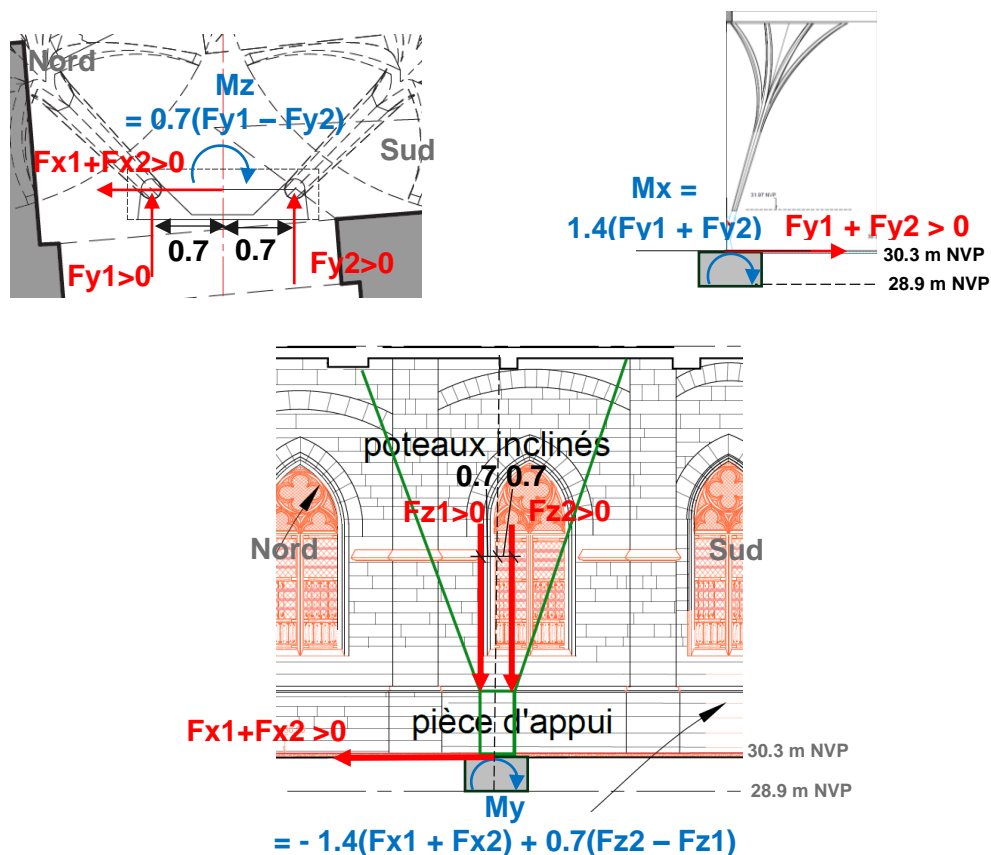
Principe de calcul du torseur à la base des fondations du doublet de poteaux 1007+1008
